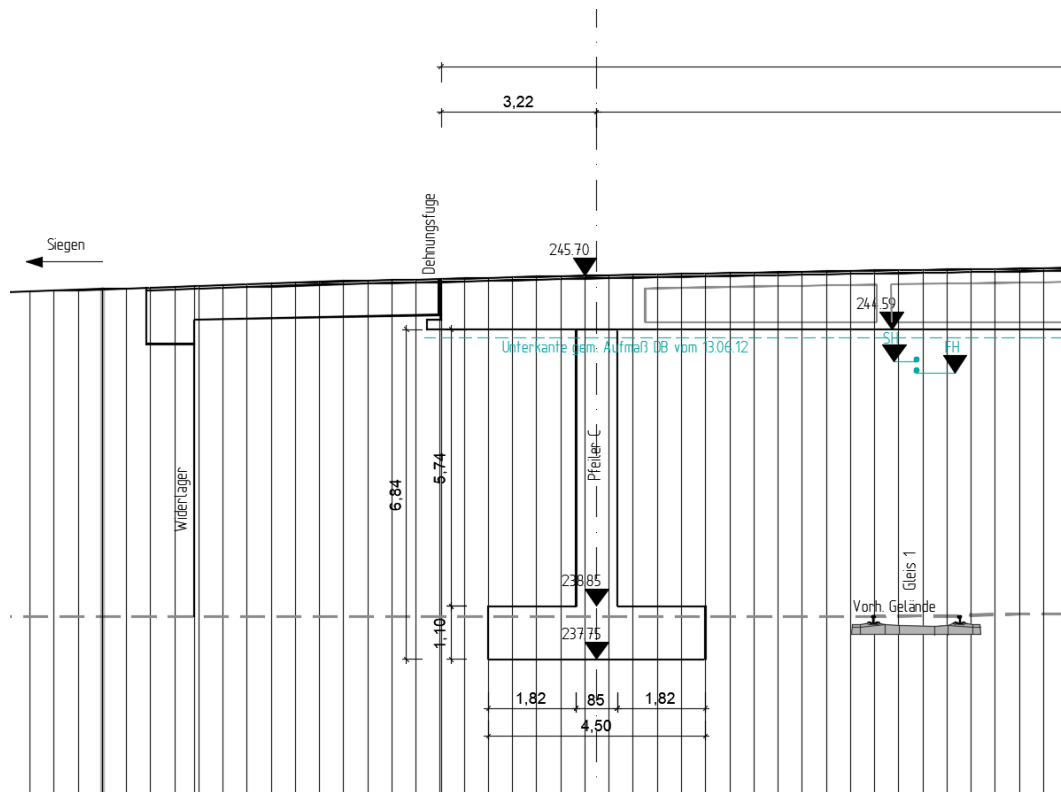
Auszug Brückenlängsschnitt (Grundlage: Top-Aufnahme Stadt Siegen)
